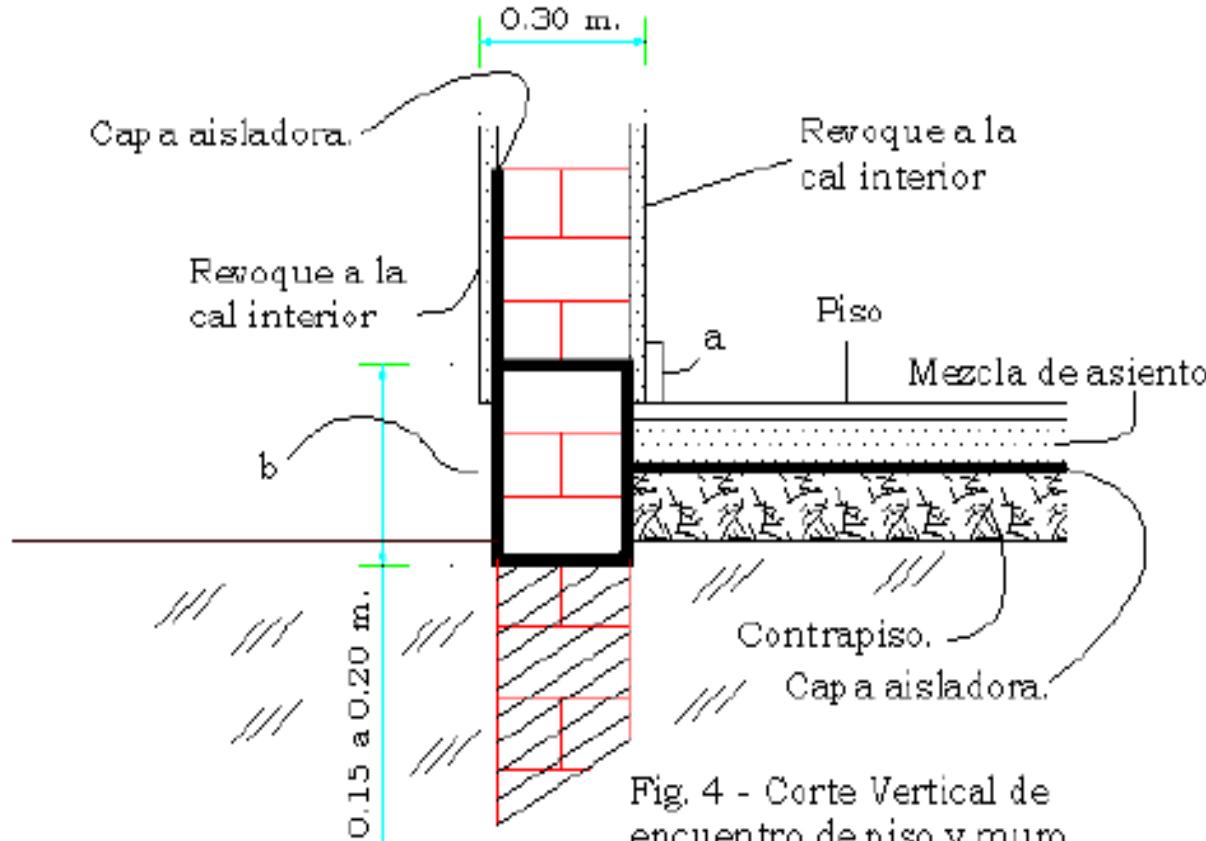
Corte Vertical de encuentro de piso y muro a nivel de terreno.
